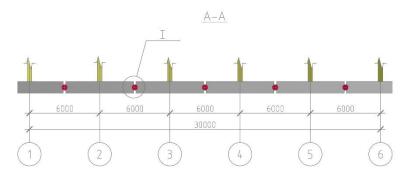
Конструкция фундаментной плиты с регулируемыми усилиями, разрез A-A: I – узел шарнирного действия
